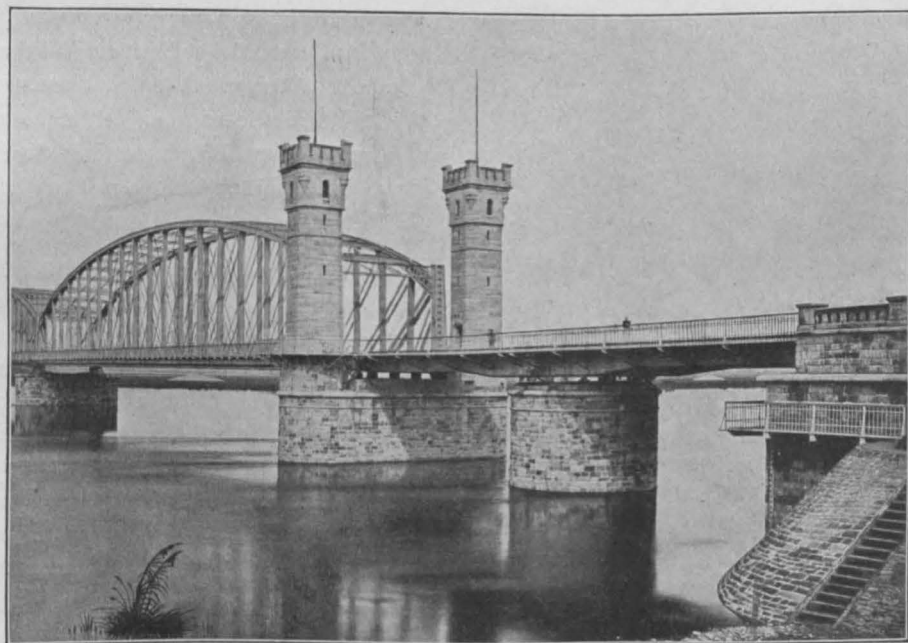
Drehbrücke der Elbebrücke bei Lauenburg (Fig. 791). SCHWEDLER.
